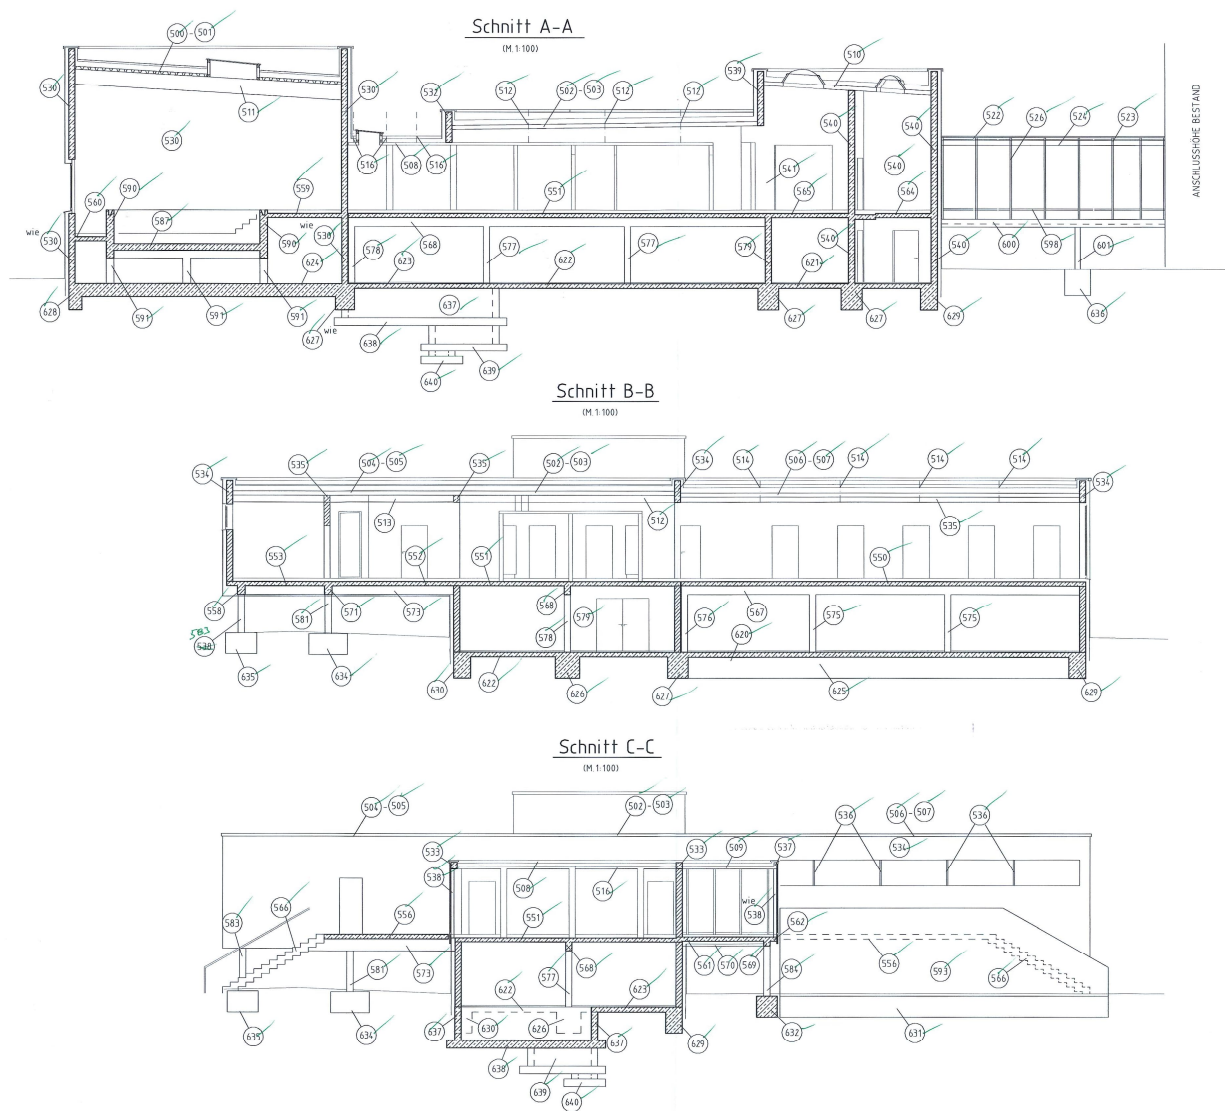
Positionsplan P9 Grundriss Schnitte vom 15.10.2003
